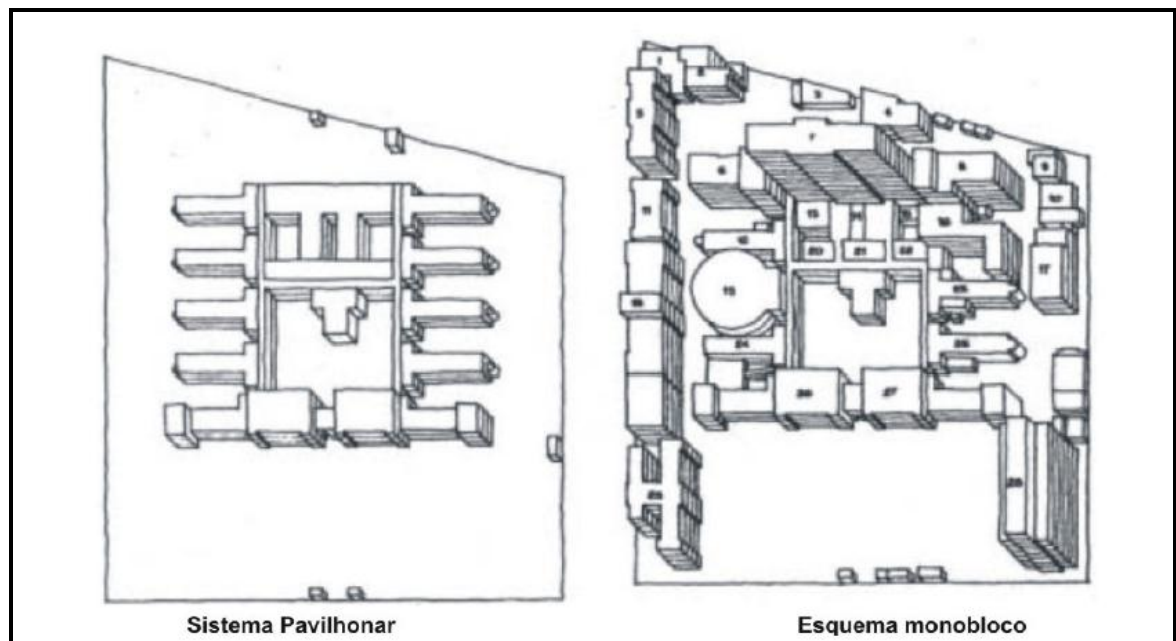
Esquema de construção pavilhonar e monobloco.
